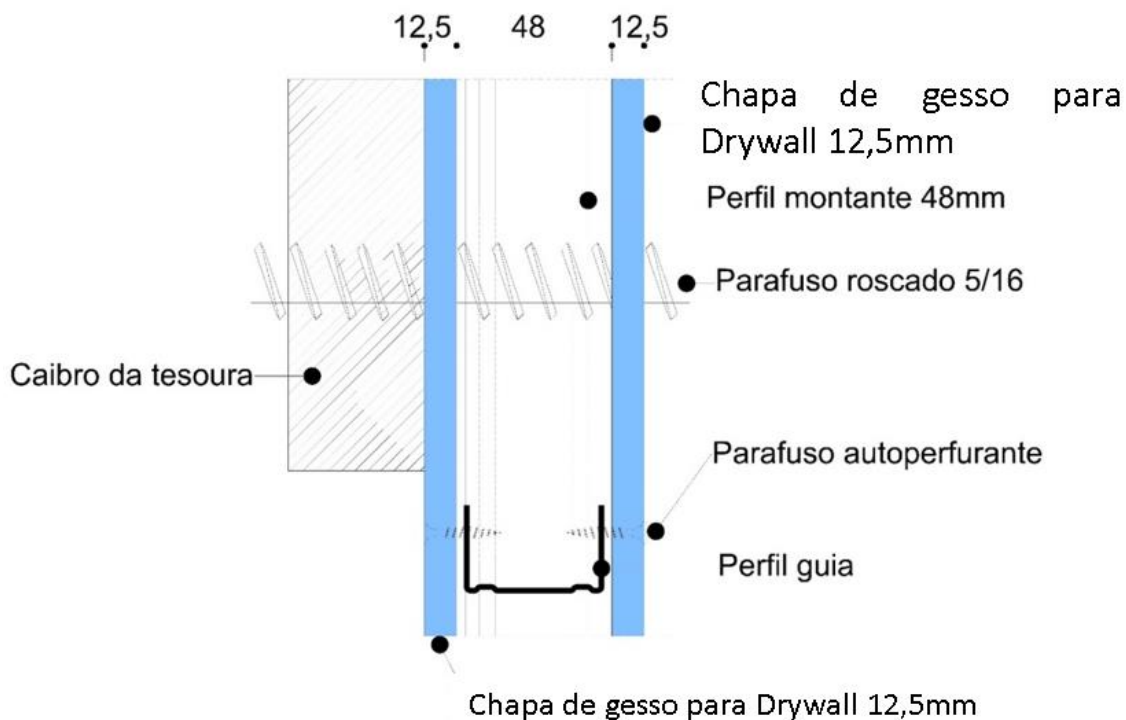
Corte - Fixação das chapas de gesso para *drywall*.
